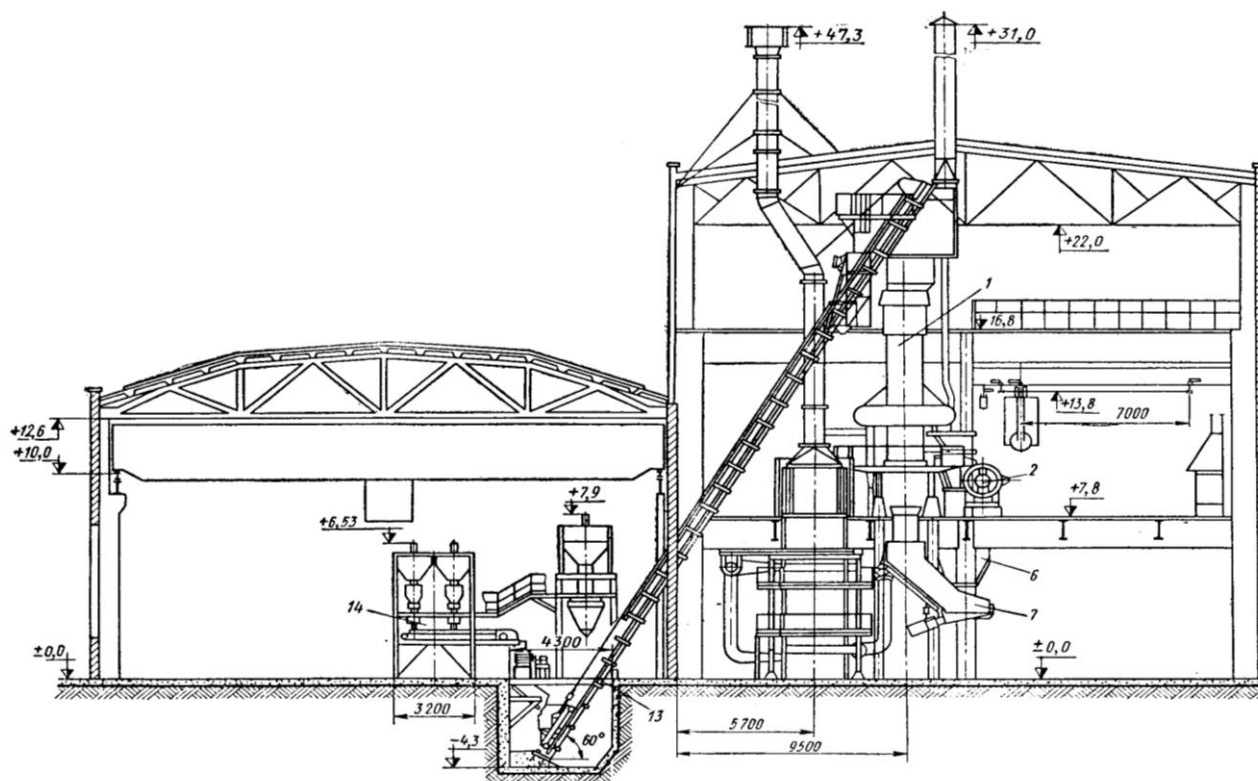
Поперечний розріз вагранкового і шихтового прольотів чавуноливарного цеху
